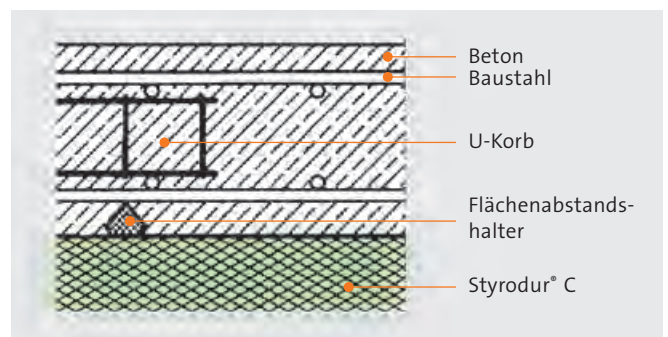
Begehbarer Flächenabstandshalter aus Faserbeton für die untere Bewehrung und Baustahlgewebeunterstützungskorb für die obere Bewehrung der Bodenplatte.
